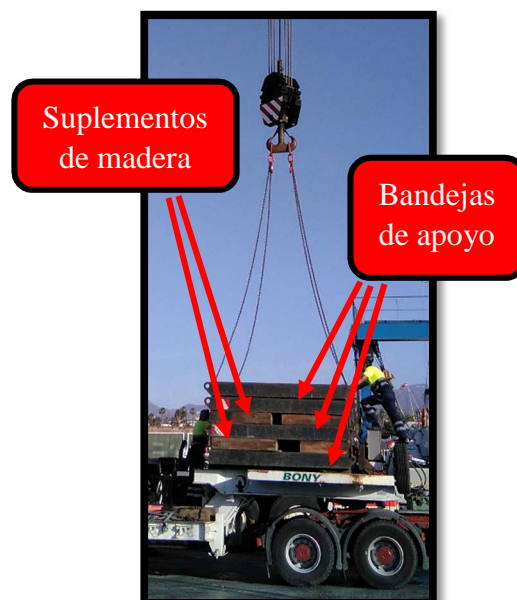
Grúa LTM 1400 izando las bandejas de apoyo.
